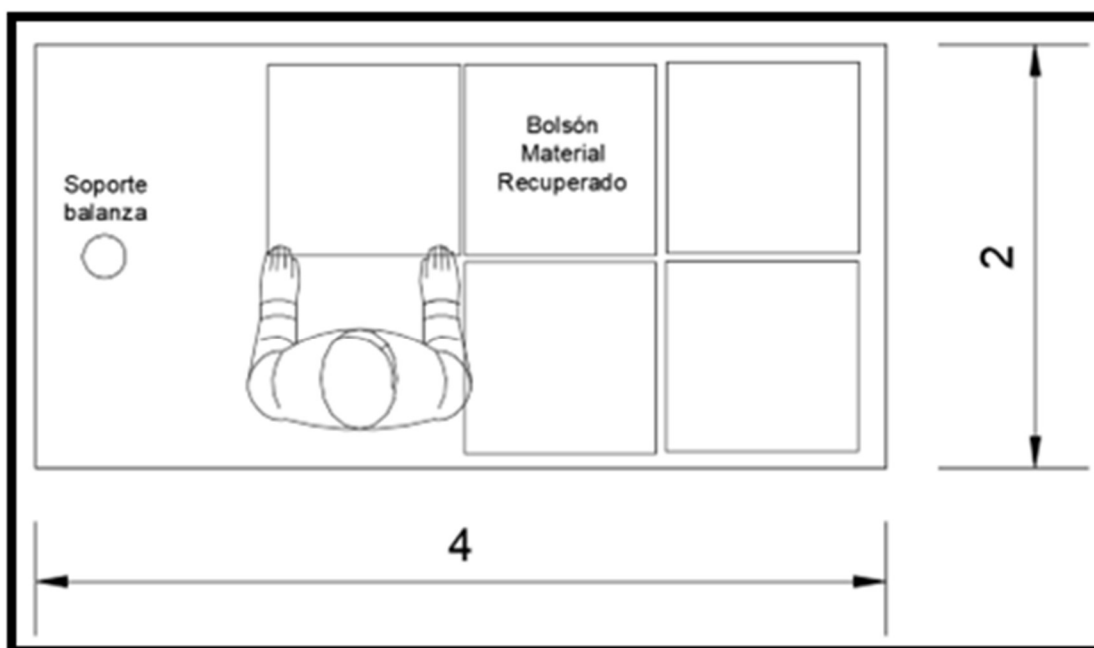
Detalle Área de Pesaje – Fuente: elaboración propia
